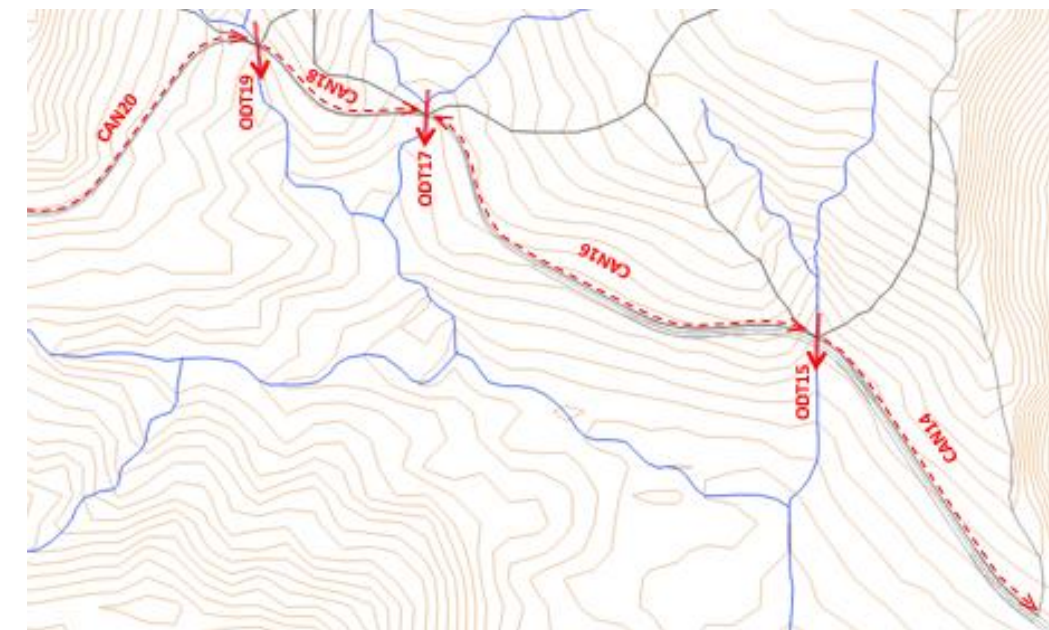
Zona norte. Drenaje longitudinal y transversal. Alternativa 2
